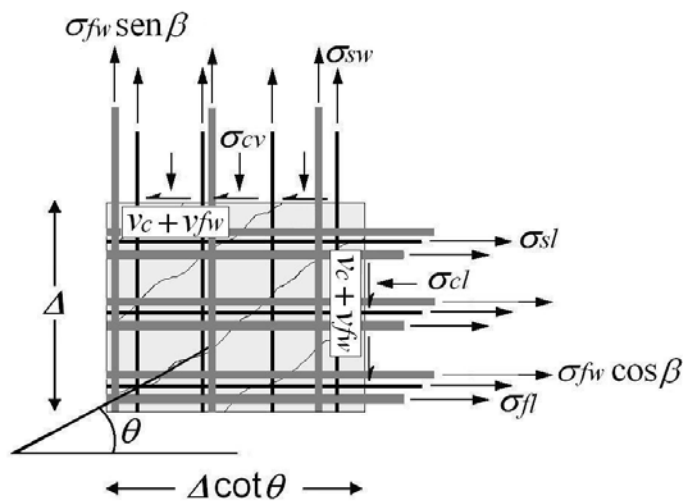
Elemento fissurado de viga com reforço externo transversal decomposto.
